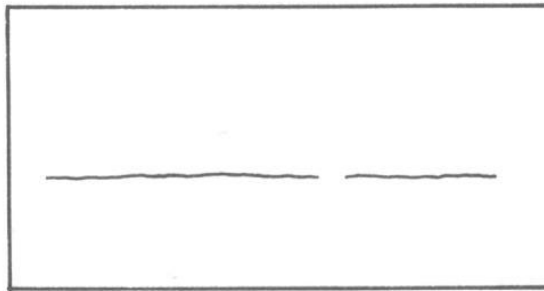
Trincas horizontais na alvenaria provenientes de sobrecarga.
